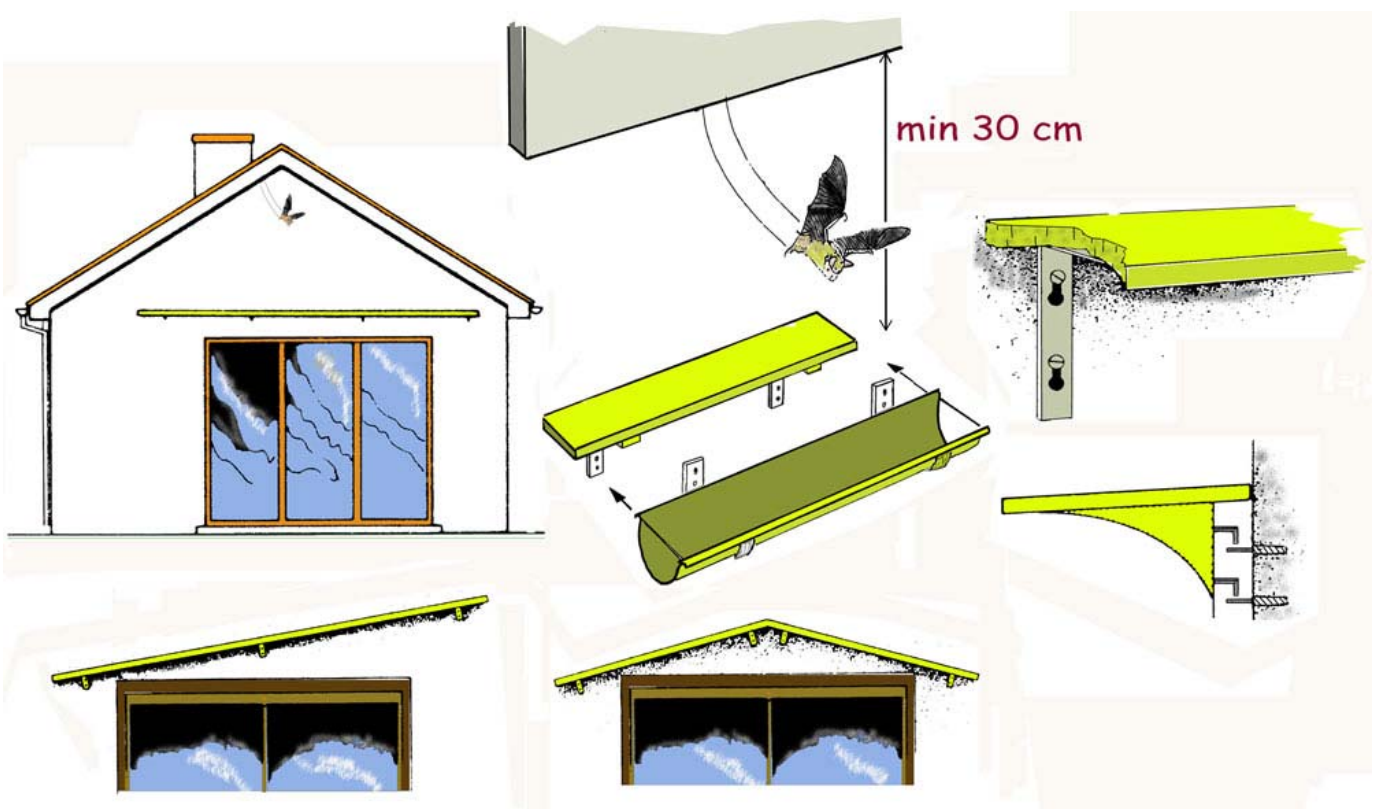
Protezione di elementi di facciata dalle deiezioni dei pipistrelli (in parte tratto da: Mitchell-Jones e Mc Leish, 1999, modificato).
